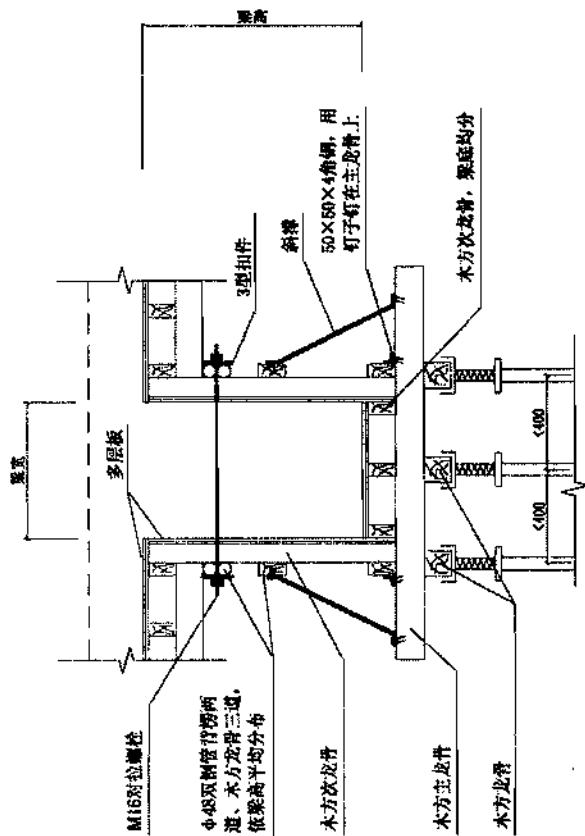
混凝土柱件的木模板拼装示意图
